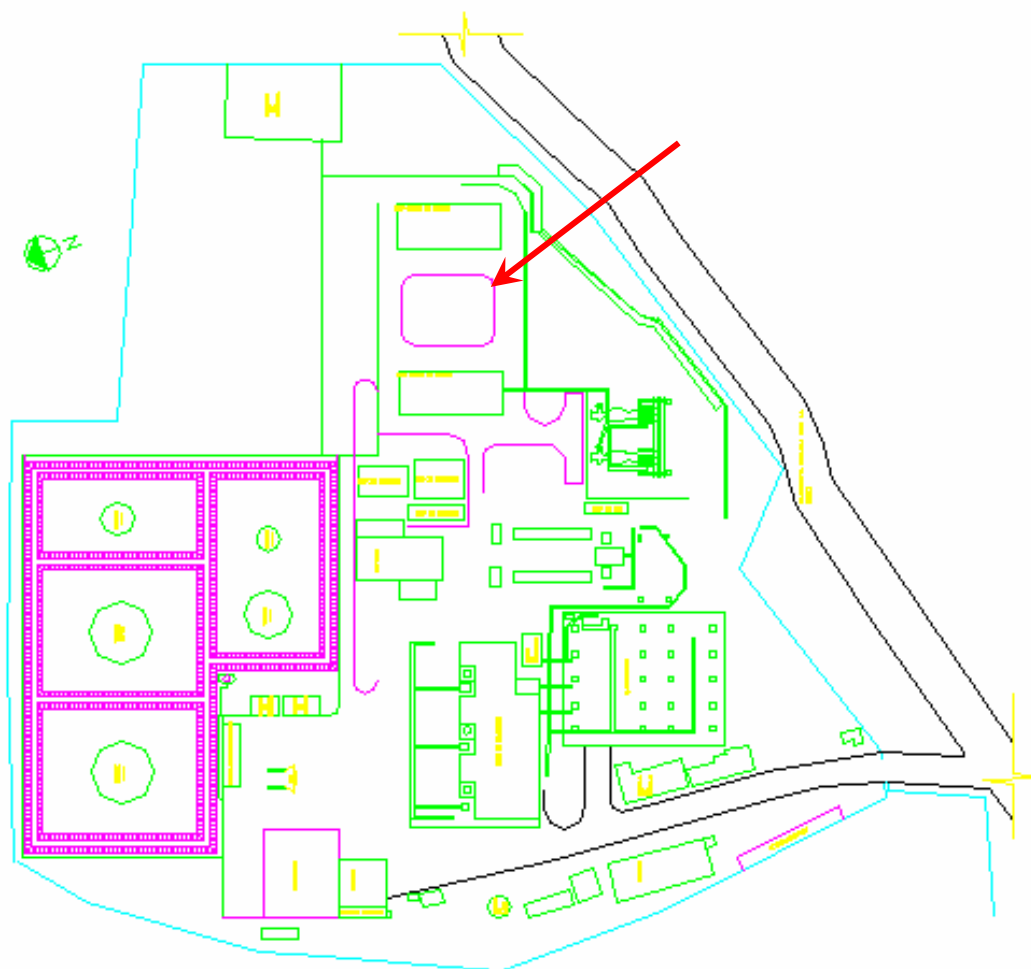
, Plano de planta Guanta, se observa la ubicación sugerida para la instalación de la unidad
